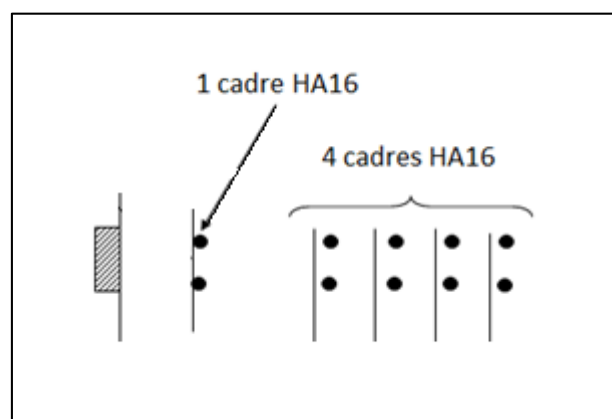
Ferrailage de la zone d'about au tour d'une plaque d'ancrage
